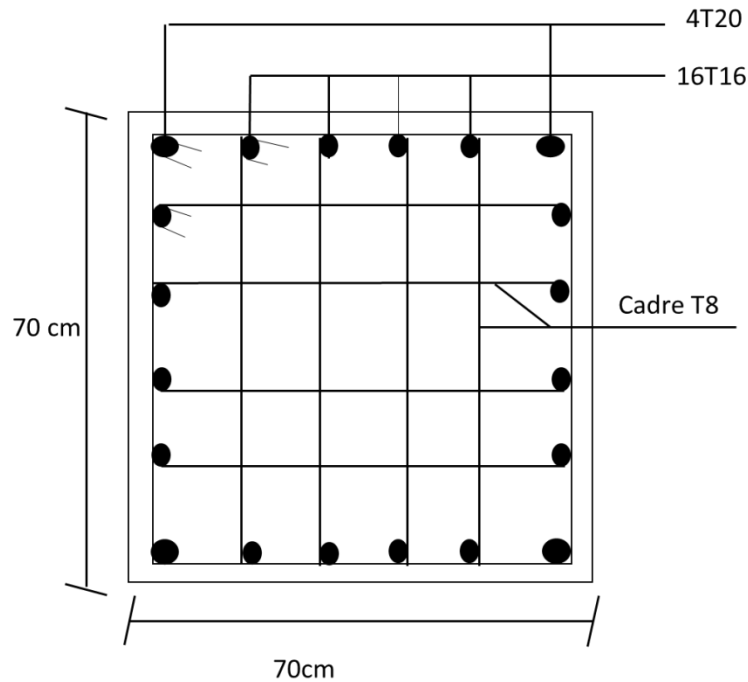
schéma du ferrailage Poteau RDC et sous-sol.
